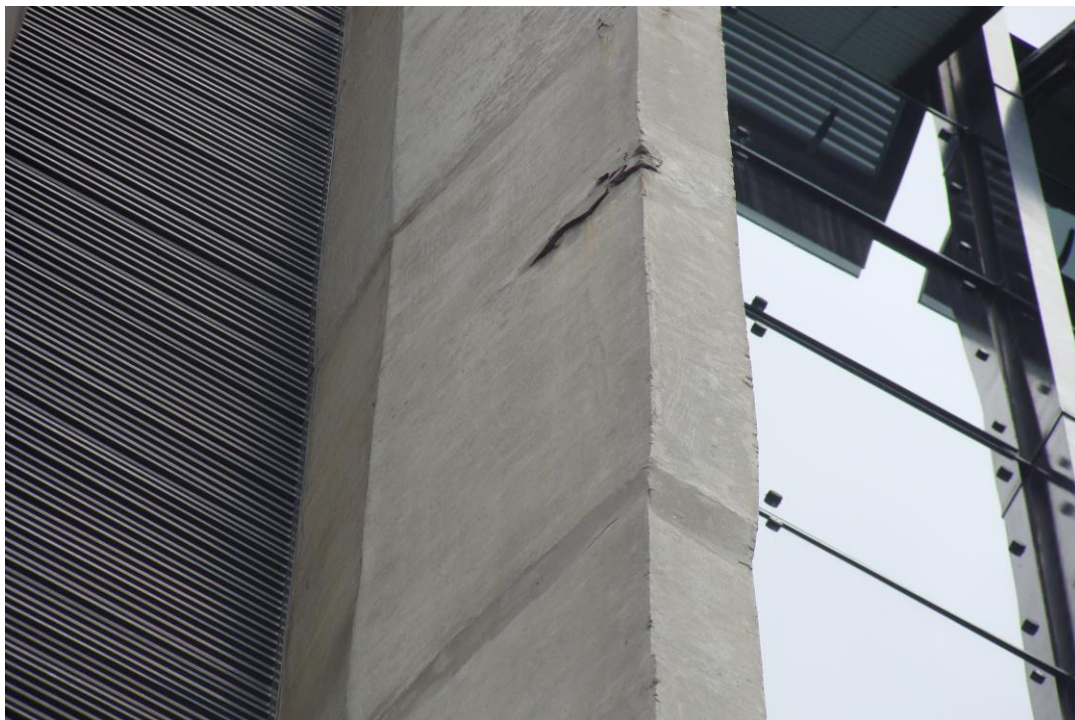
Armadura exposta pilar P11 (5º pavimento) (19/11/2013)
